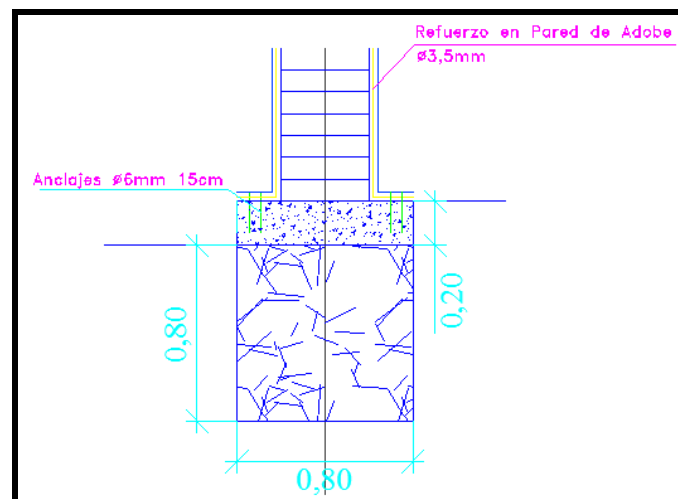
Corte de Refuerzo en la base de muros de adobe
